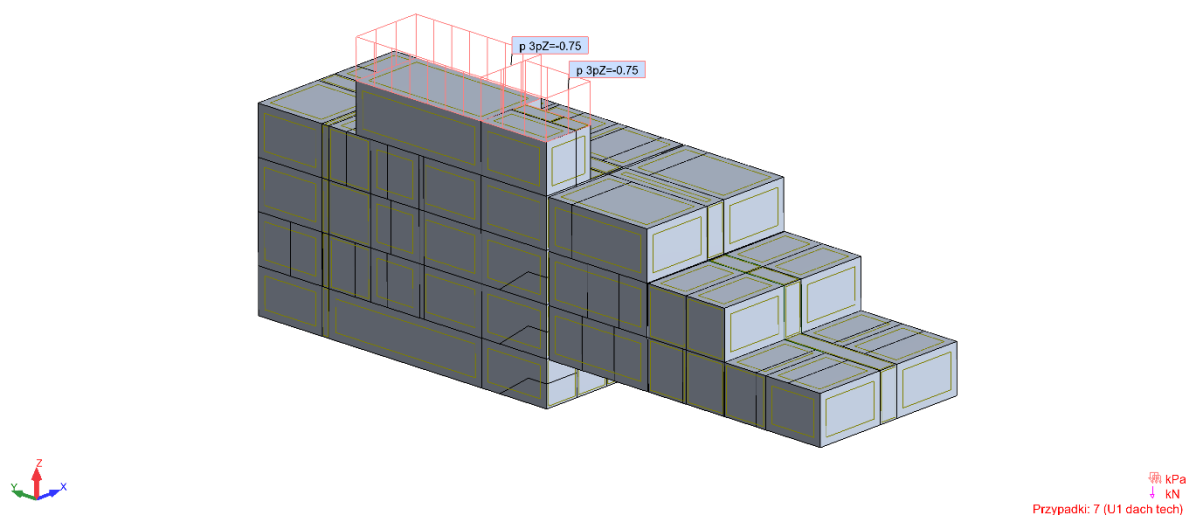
Przypadek obciążenia stałego od dachu ekstensywnego
